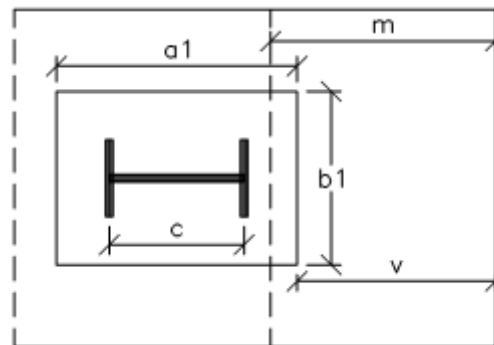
Vuelo de cálculo en una zapata con pilar metálico.
